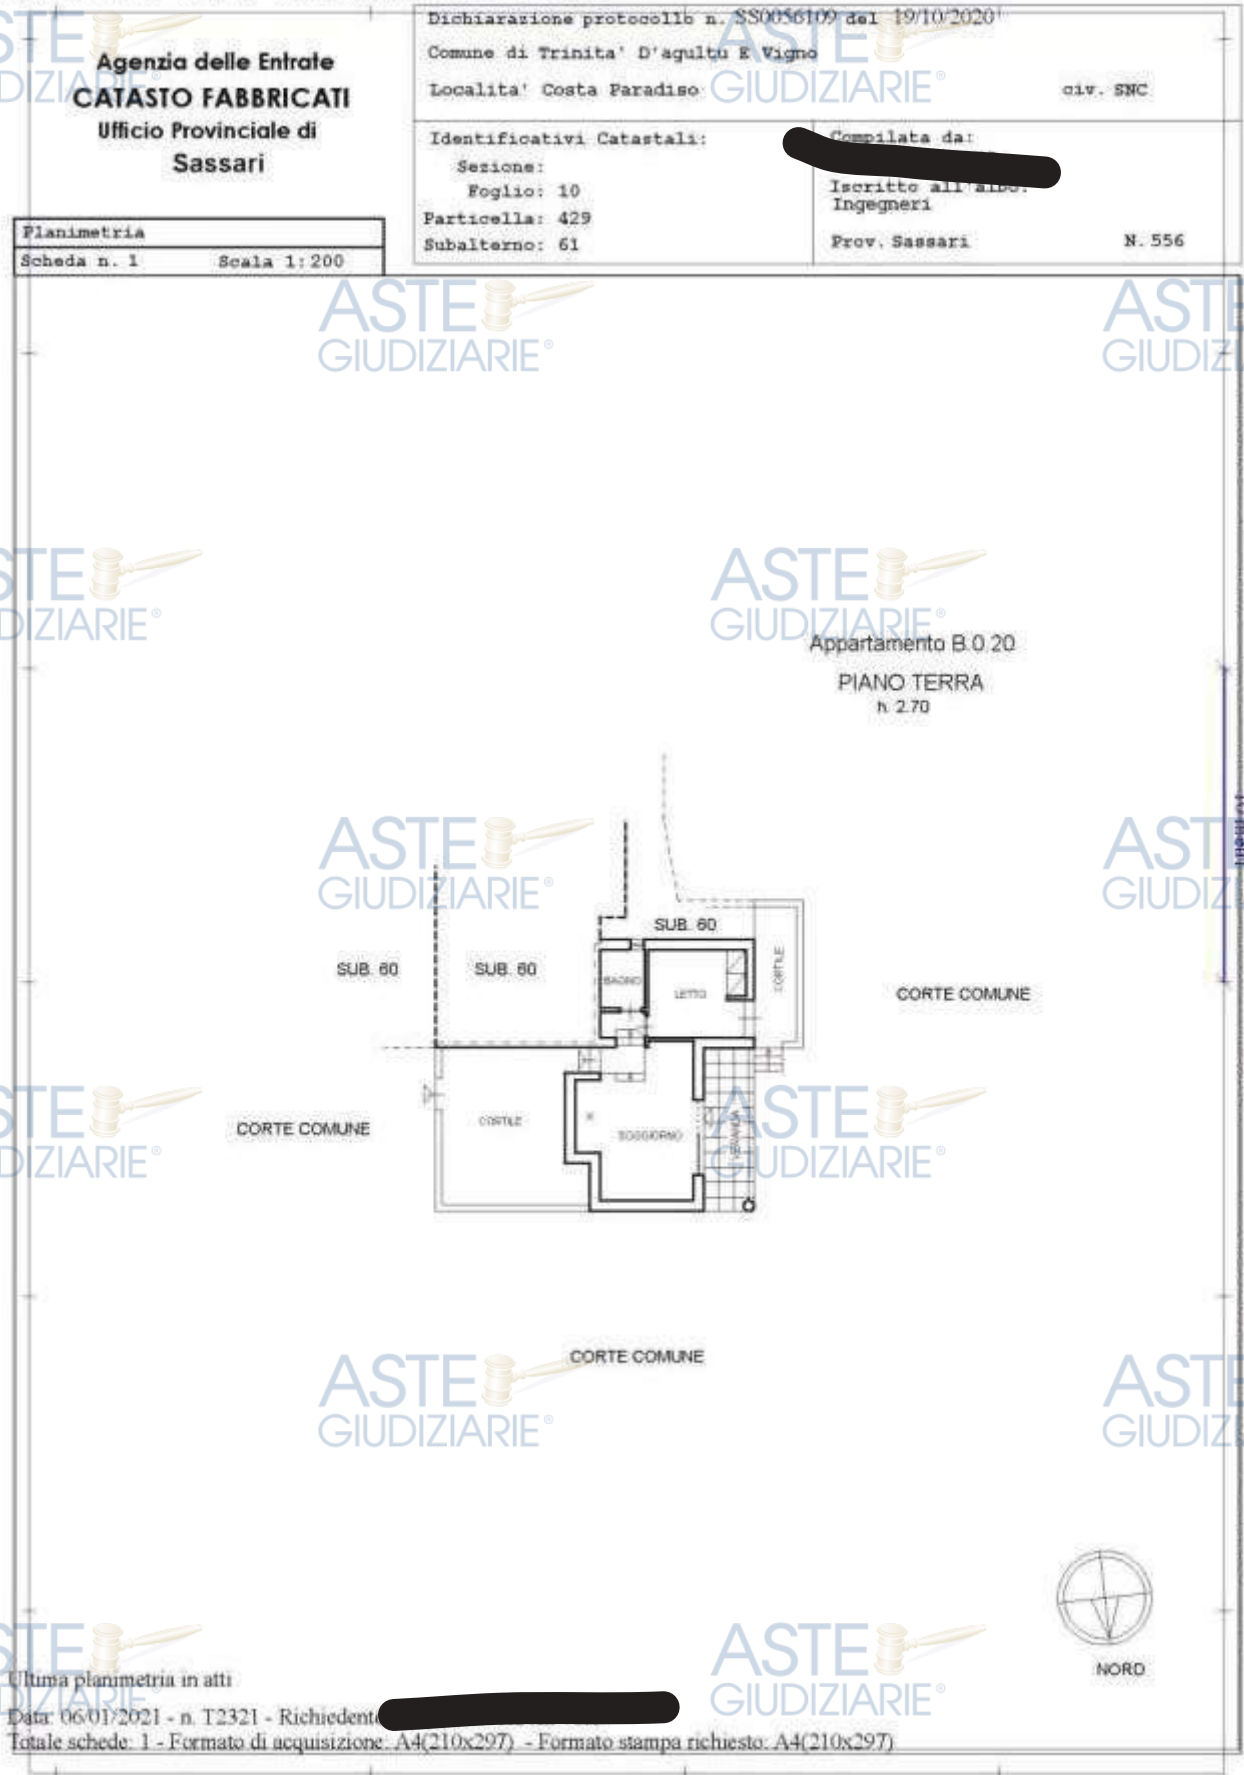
Visura planimetrica catastale Fig. 10 Part. 429 Sub 61 (ex Fig. 10 Part. 429 Sub 20)
